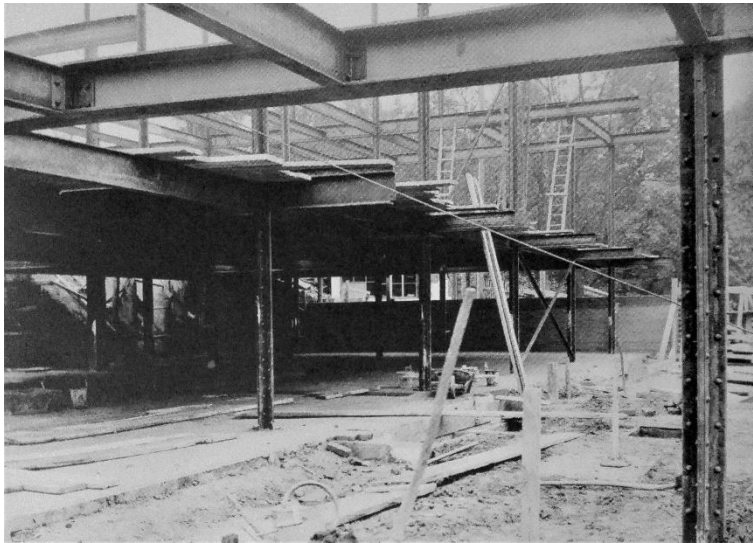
Casa Tugendhat em construção no ano de 1929, esqueleto estrutural em aço.
